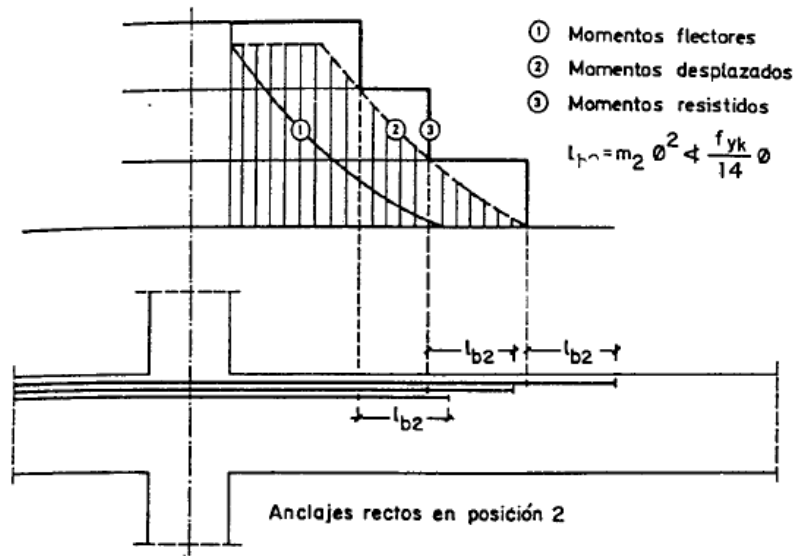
Ejemplo de anclaje de barras rectas sobre apoyo.
